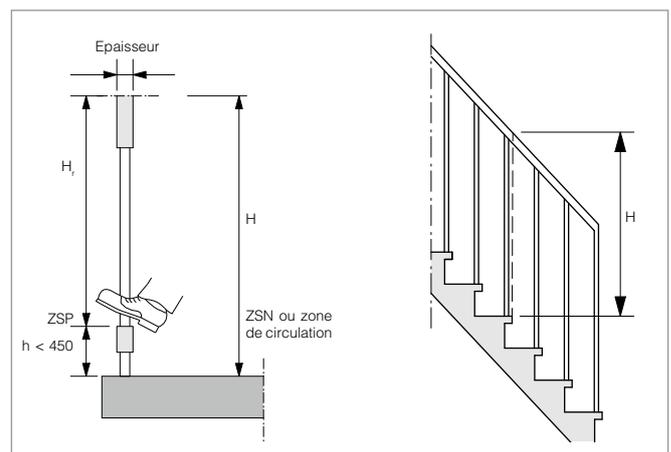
Hauteurs de protection des garde-corps et des rampes d'escalier (mm).
